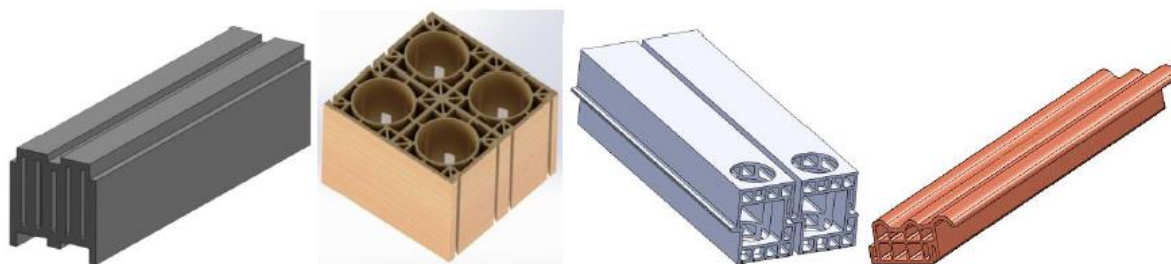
Отдельные элементы универсального набора (слева-направо: фундаментный блок, рядовой стеновой блок, балка перекрытия, кровельная плита)
